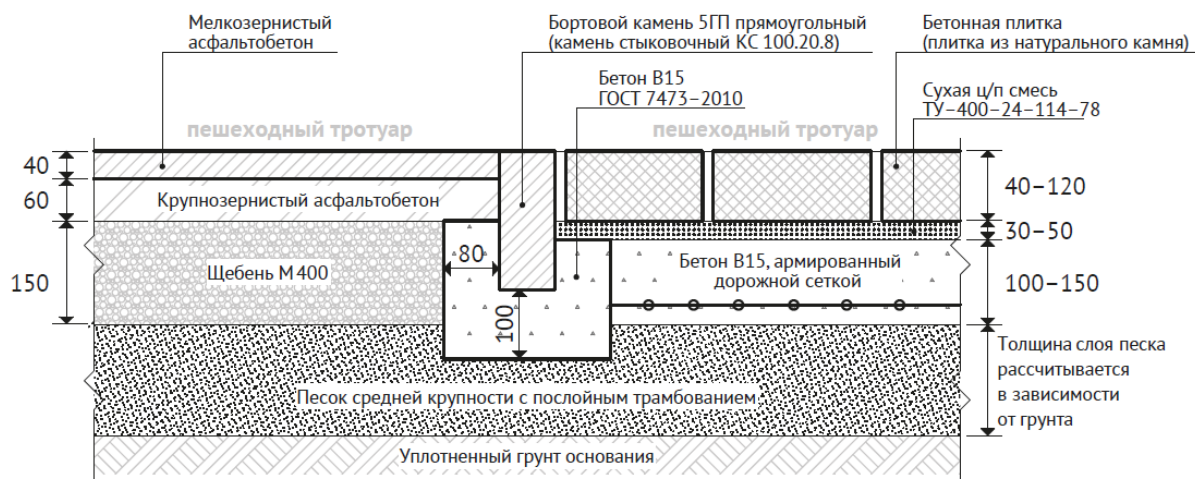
Сопряжение покрытий из бетонной плитки и натурального камня
